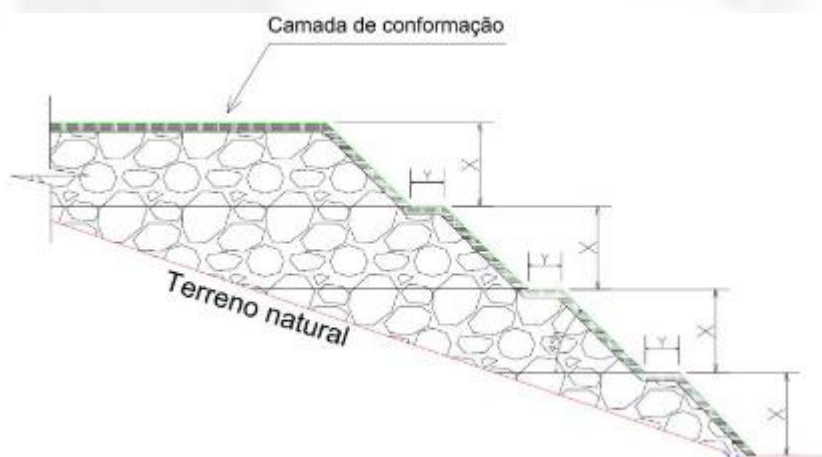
Perfil esquemático construtivo. Fonte: Plano de disposição de estéril/rejeitos.
